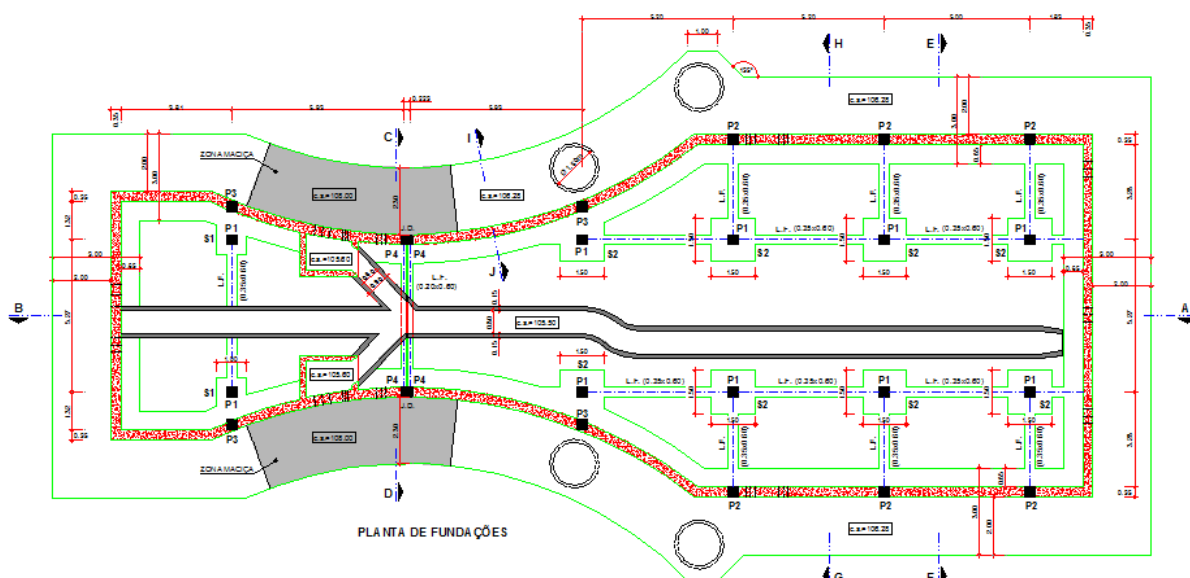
Planta de Fundações da Câmara de Manobras
